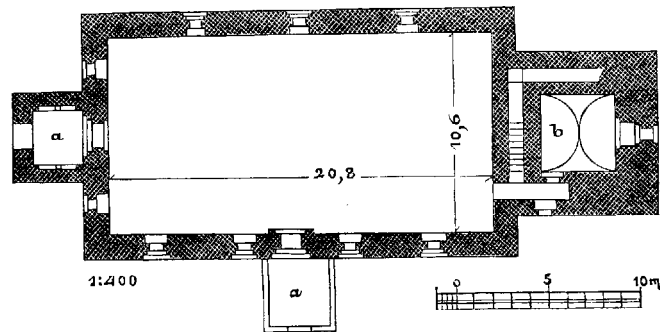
Gr. Krebs. Grundriss der Kirche.
